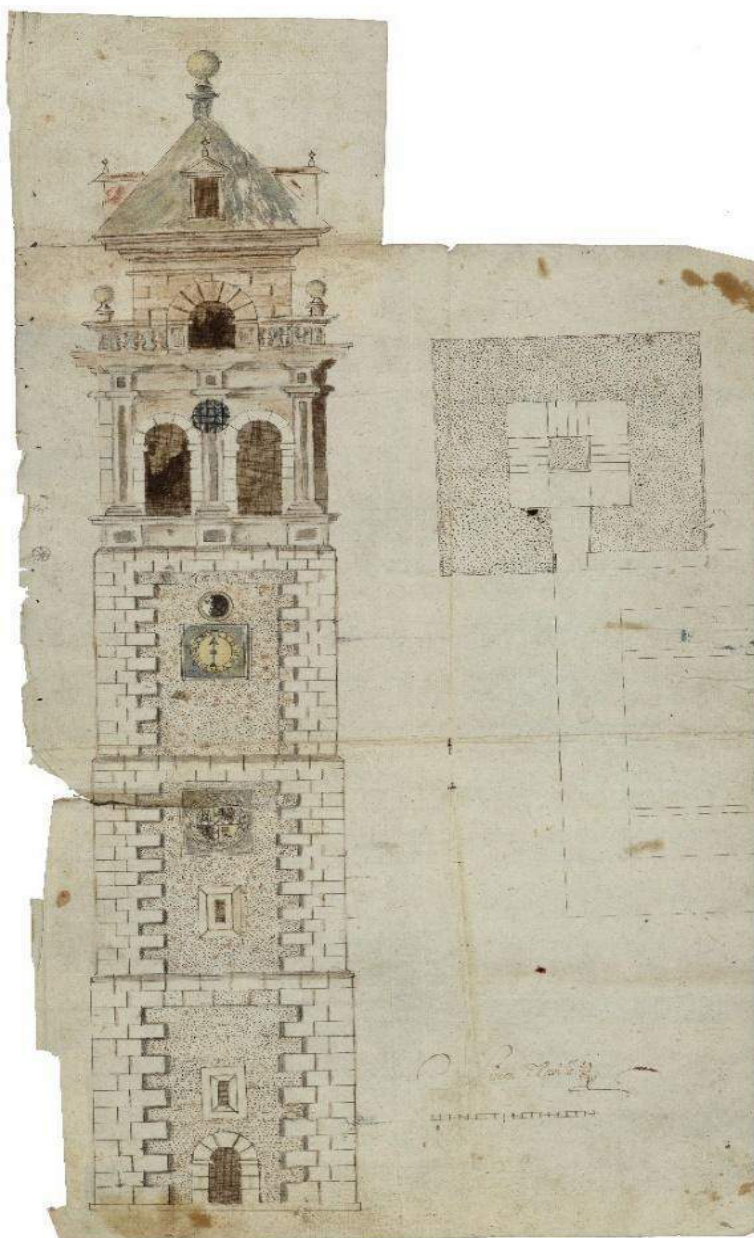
Alzado y planta de la torre de la Iglesia Colegial de Santa María de la Asunción. Simón Rosillo, 1699 (Fuente: ADM, plano nº 354)
